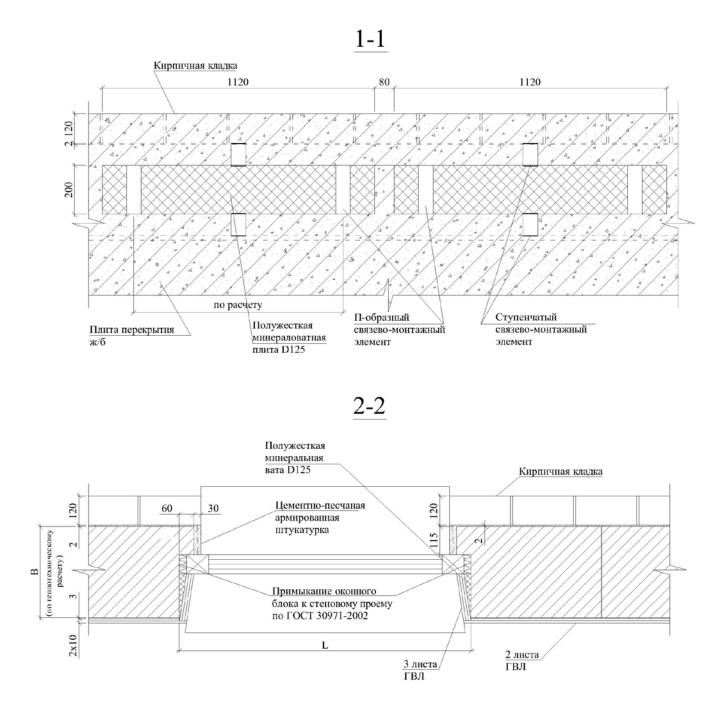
Горизонтальные разрезы по оконному проему и перекрытию
